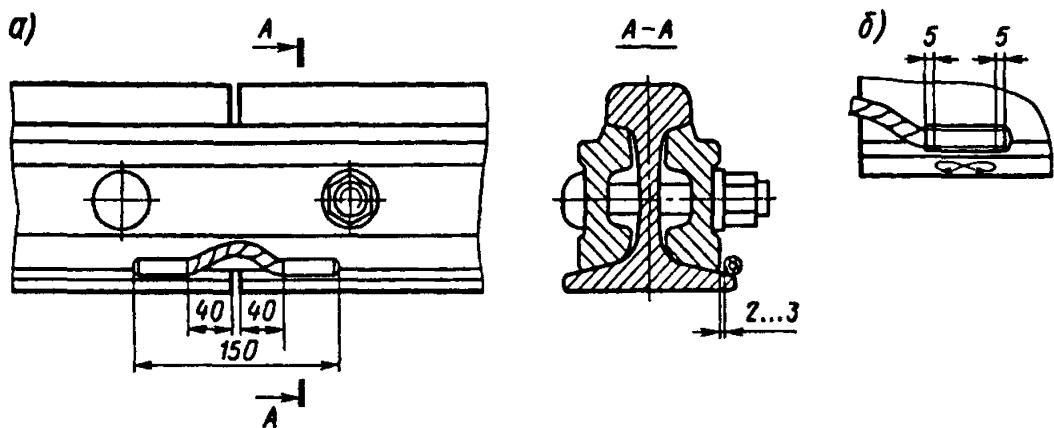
Схема установки (а) и приварки (б) соединителя к подошве объемно-закаленных рельсов типа Р65 (Р75)
